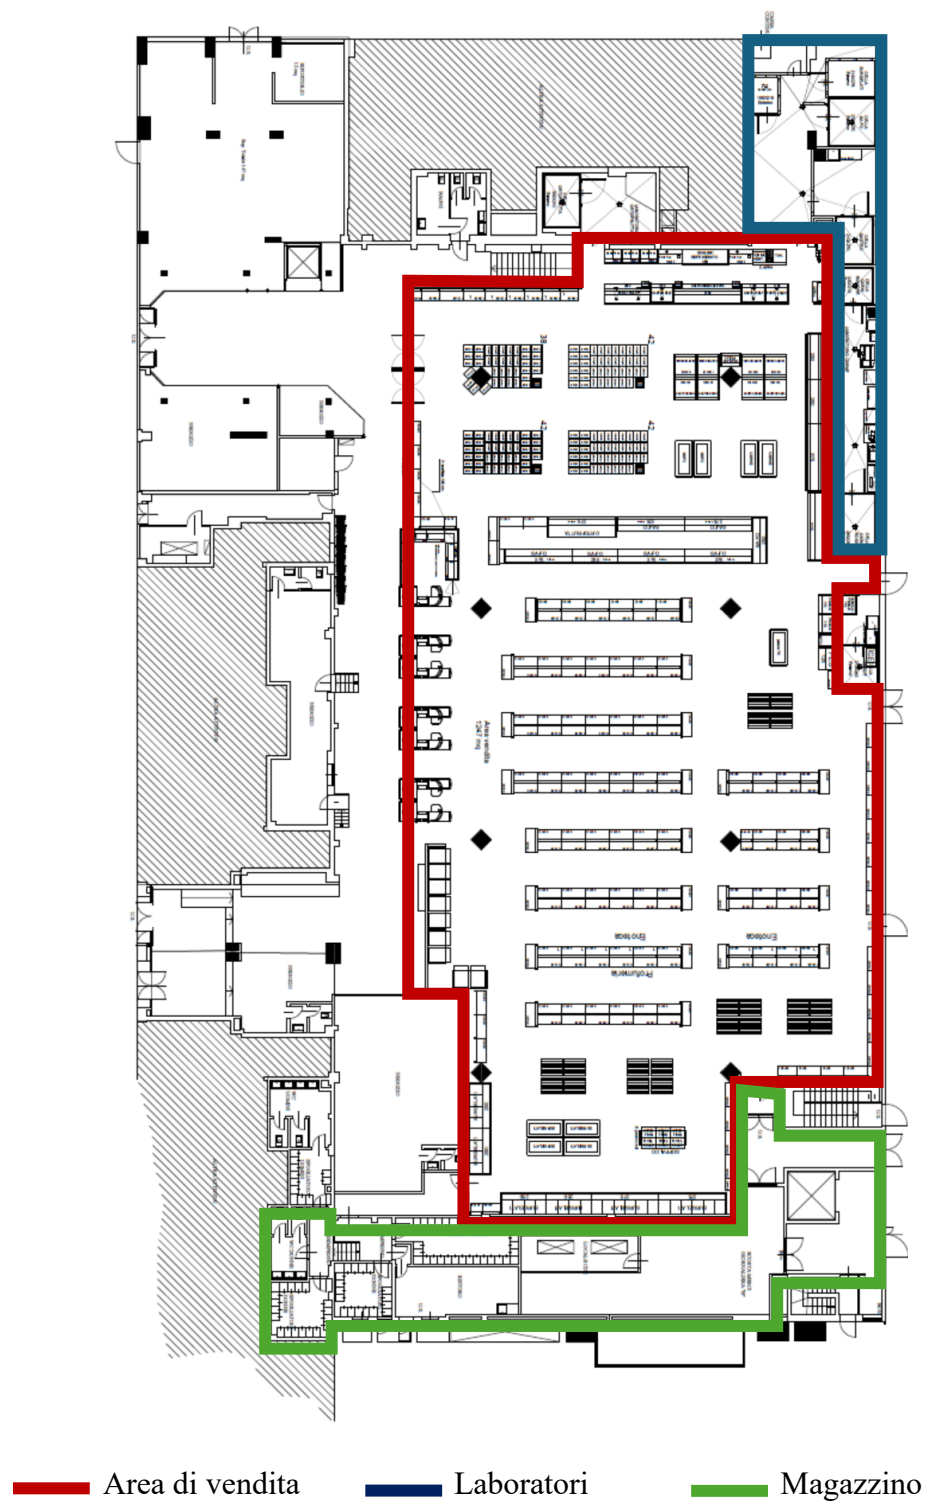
Planimetria del punto di vendita con individuazione delle tre aree di lavoro principali.
